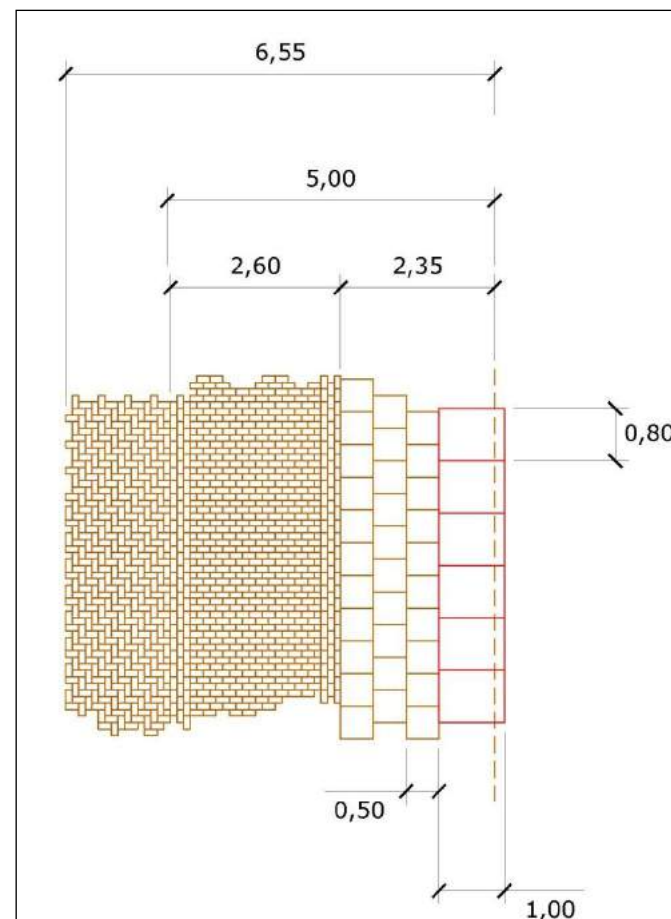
Detalle de la disposición del pavimento previsto para el paseo.
